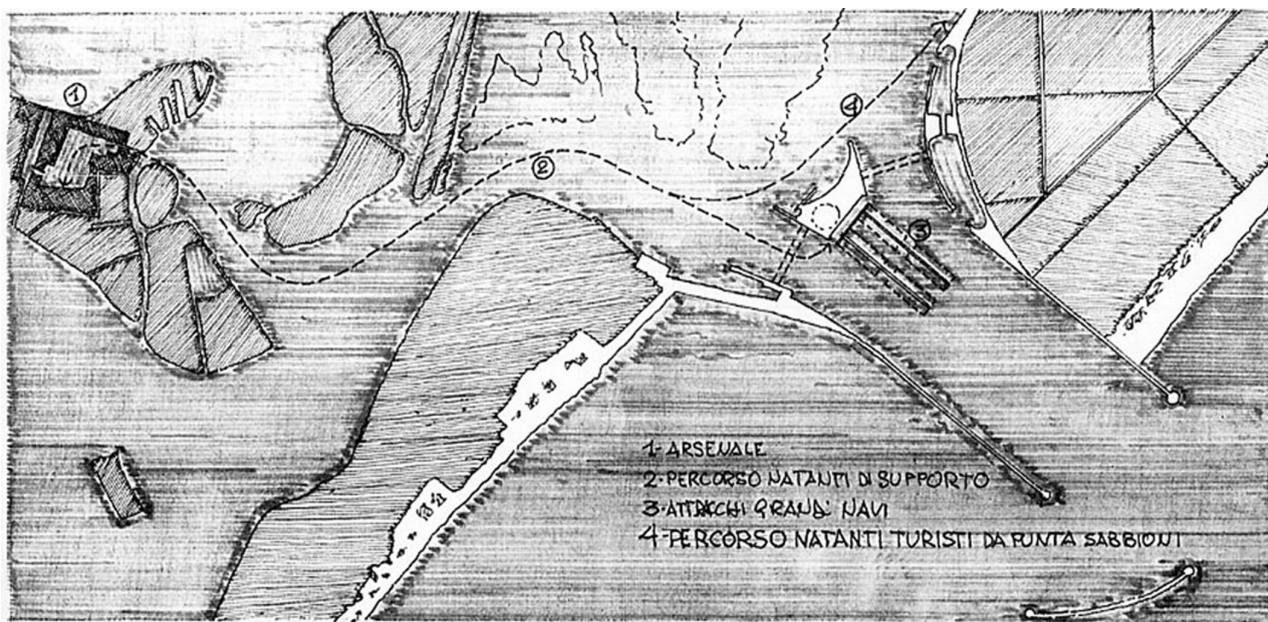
Planimetria d’insieme dell’avanporto con i collegamenti con l’ipotizzata sezione di Stazione Marittima all’Arsenale.
